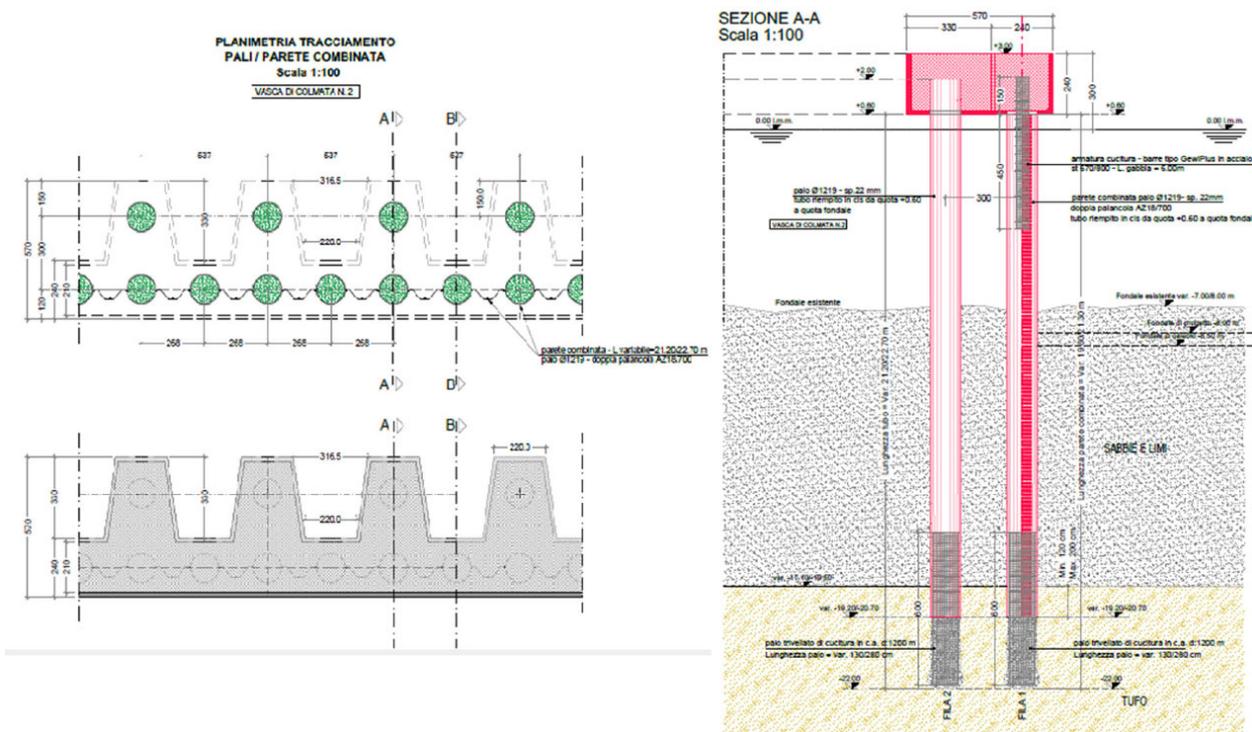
Sezione tipologica di progetto tratto B (stralcio elaborato MI061P-PDDS4022 - Progetto cassa di colmata – Sezioni)
